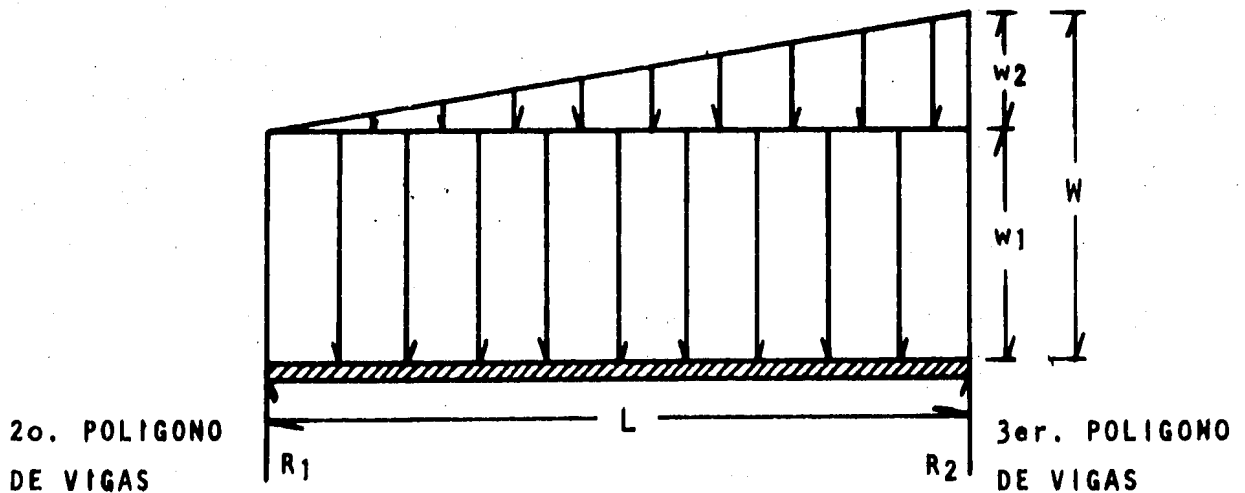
VIGA CORRESPONDIENTE A LOS TRAVESAÑOS DE LA 3a. SERIE.
